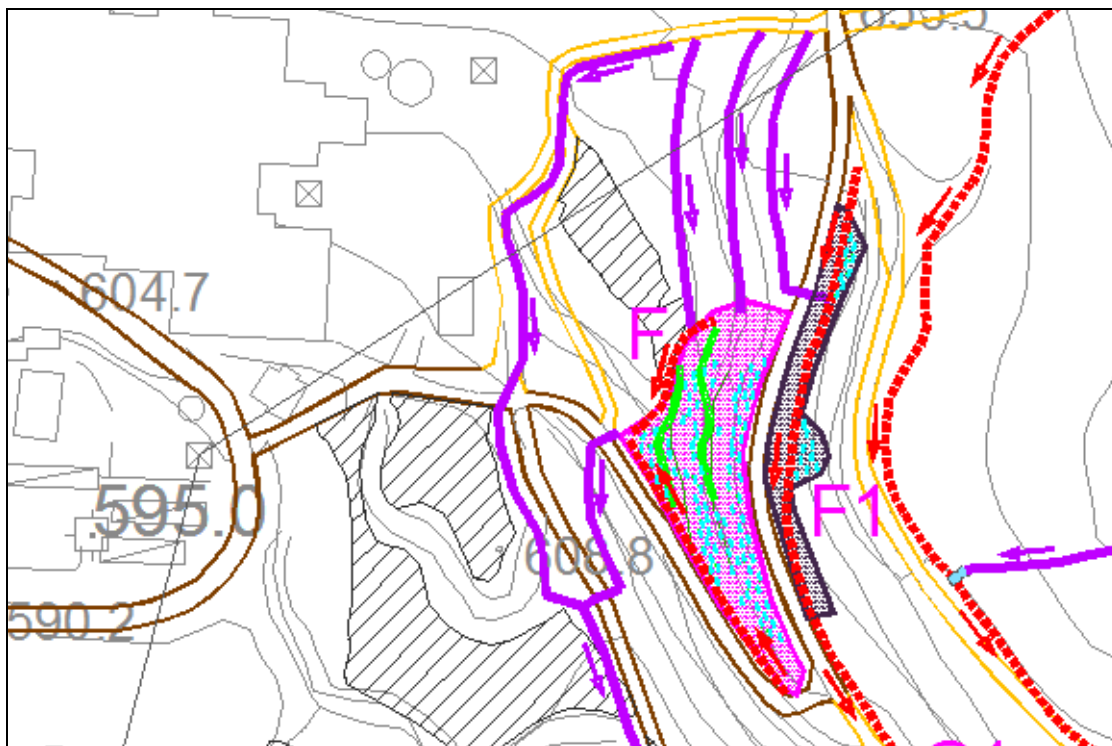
Unità progettuali F e F1 (cfr. elaborato C2 - Planimetria generale di progetto)
